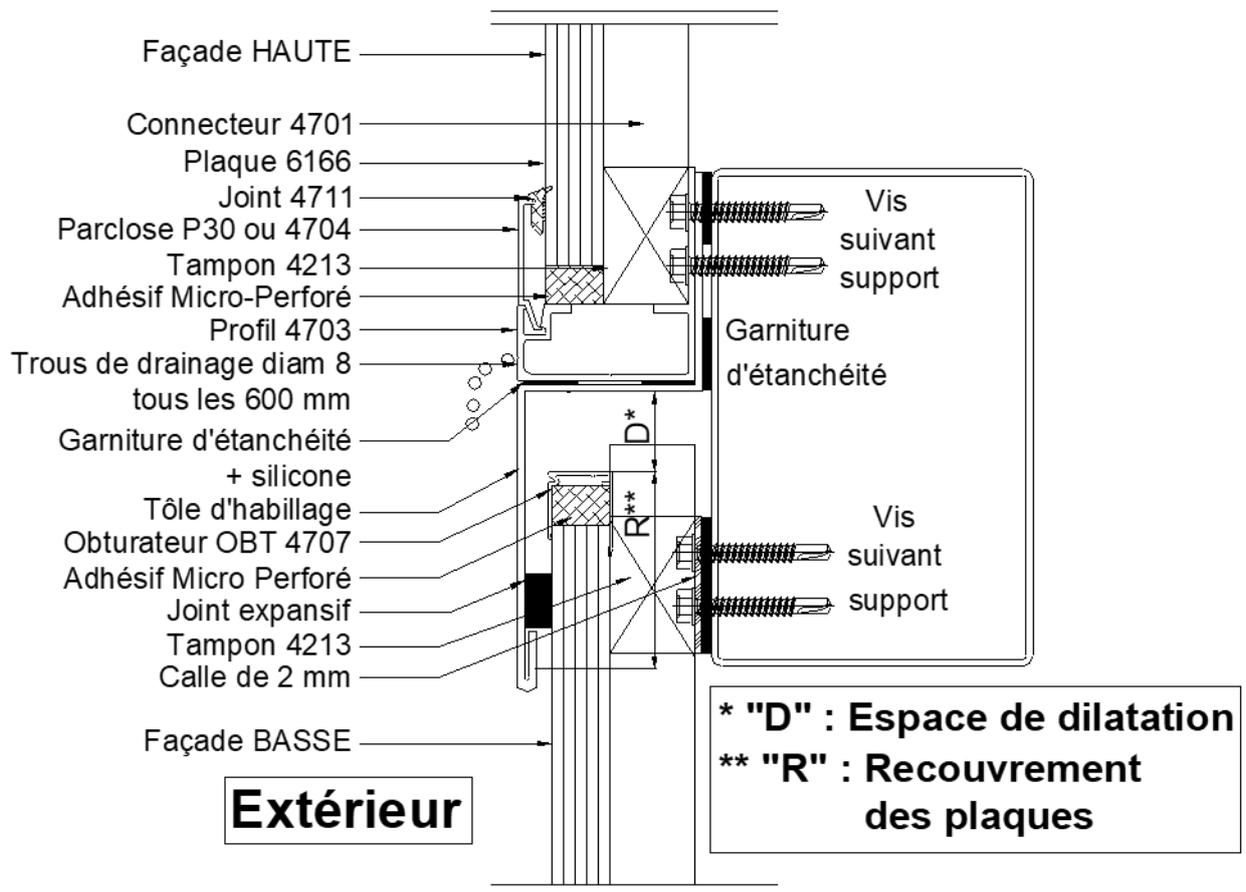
Raccord de hauteur (façade basse inférieur à 16 m de haut)
